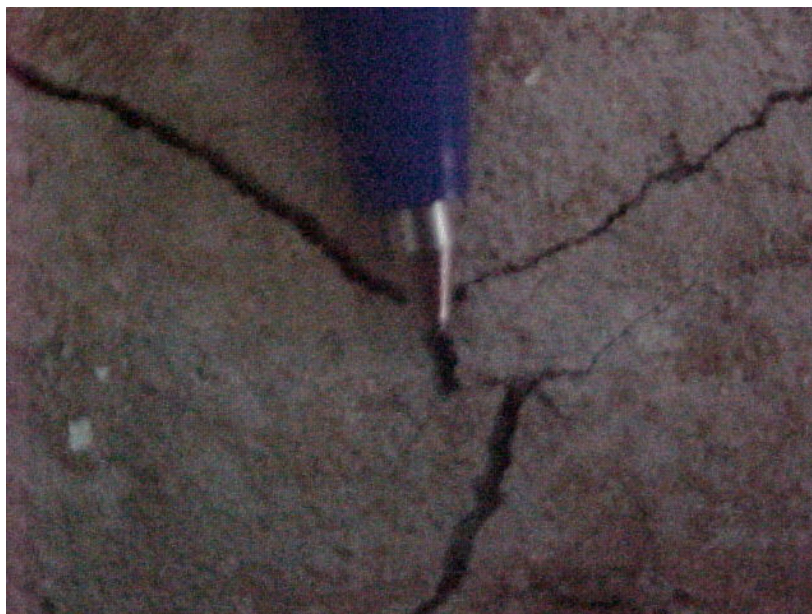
Detalhe da trinca no contorno do pilar
